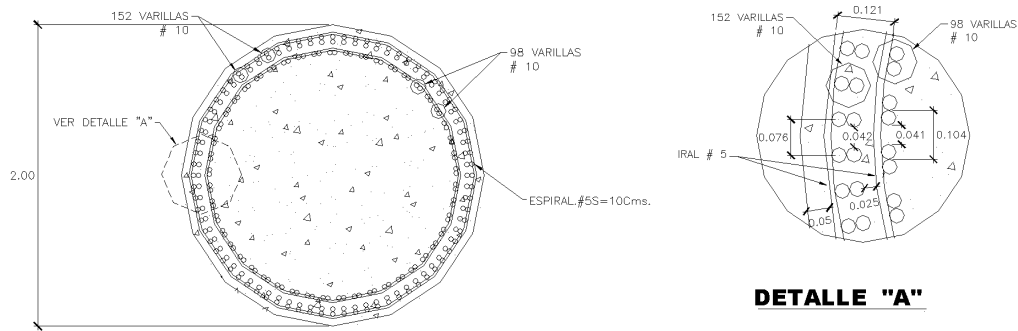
Detalle del Refuerzo para Sección Transversal de Pila 8
